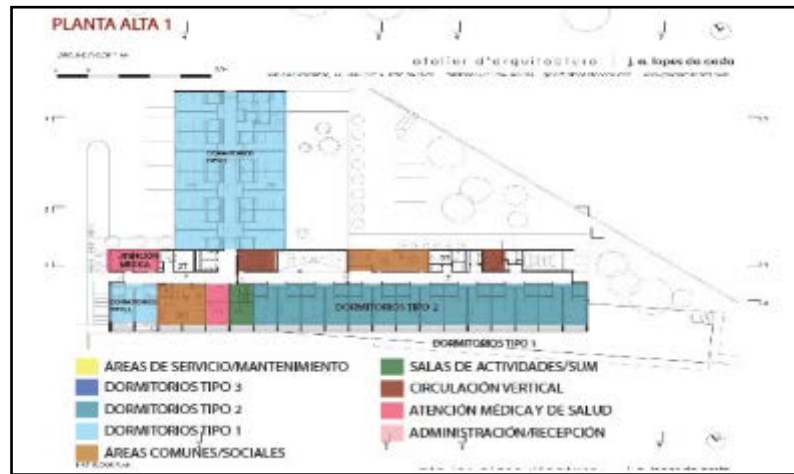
IMAGEN ZONIFICACION PLANTA ALTA
